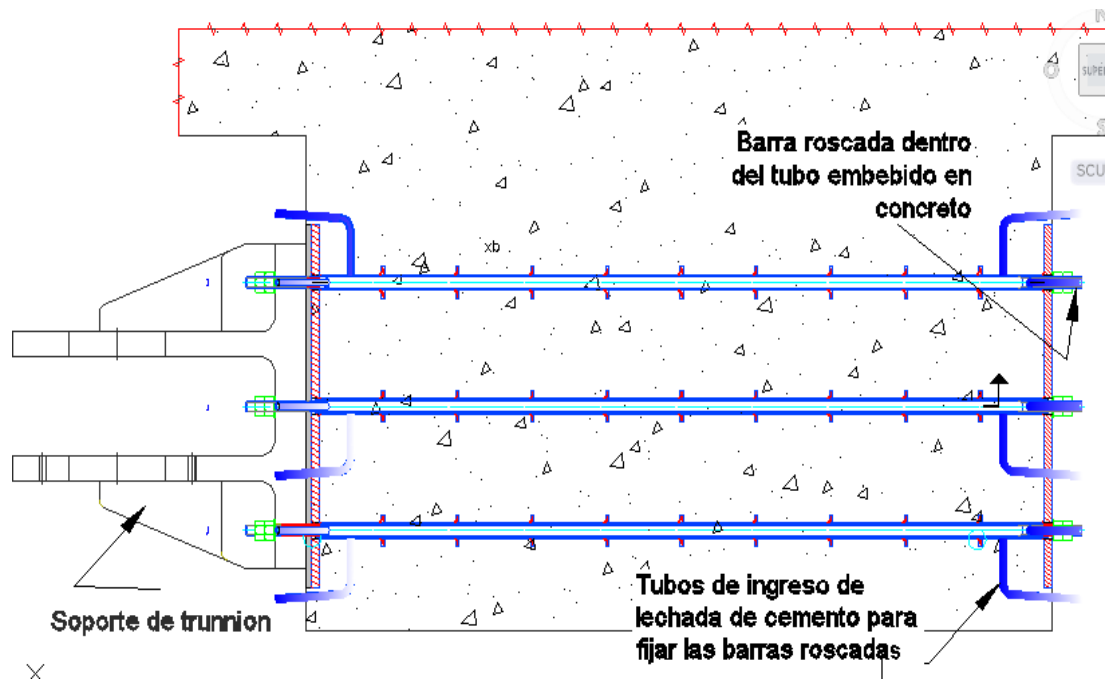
La viga trunnion esta embebido en concreto. Fuente: Propia.
